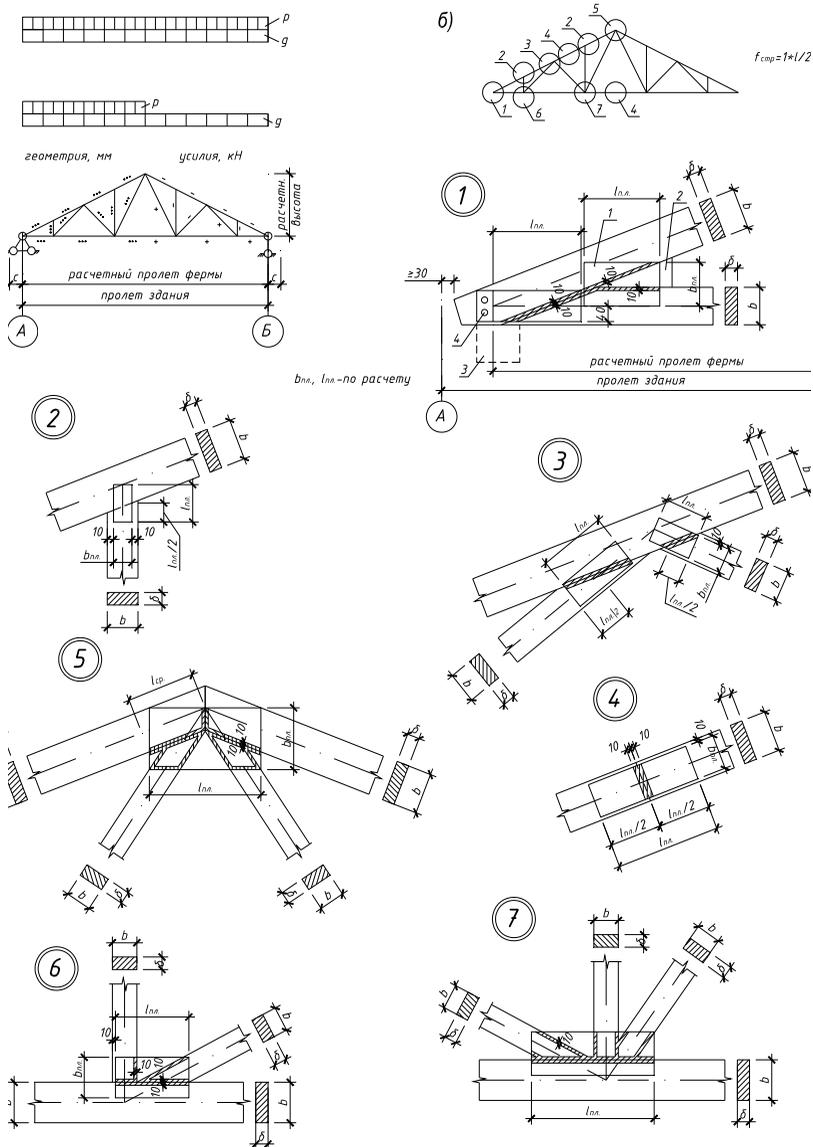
Узлы треугольной дощатой фермы на МЗП:
